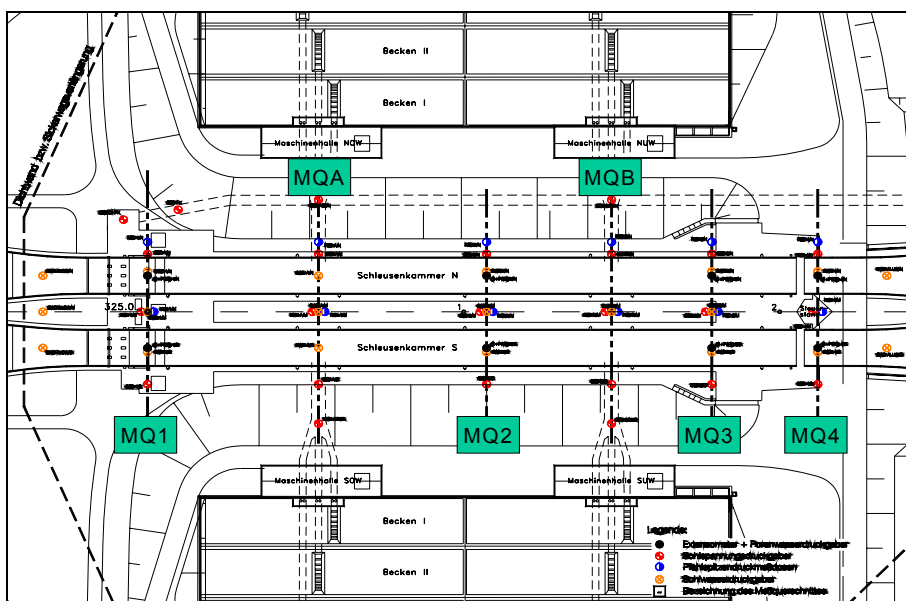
Lage der Messquerschnitte im Grundriss der Schleuse
